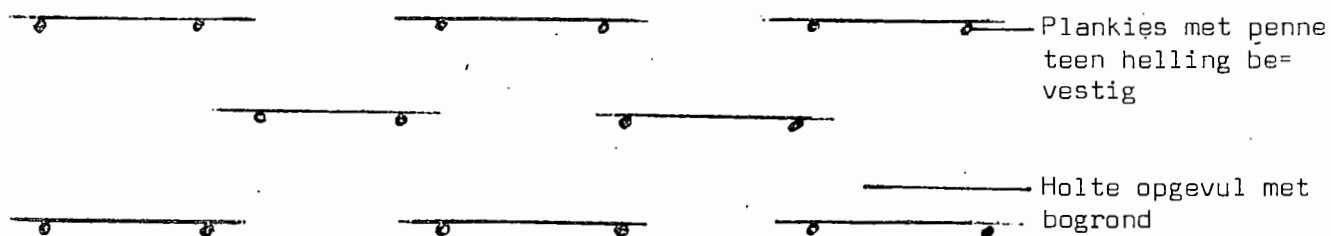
PLASING VAN PLANTEGROEIROLLE
